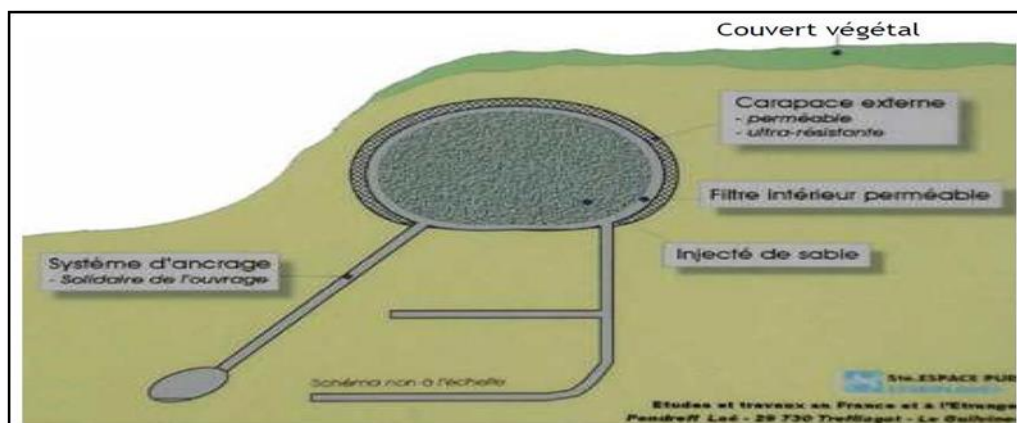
Schéma de fonctionnement d'un STABIPLAGE en pied de dune (<http://www.stabiplage.com/>)
